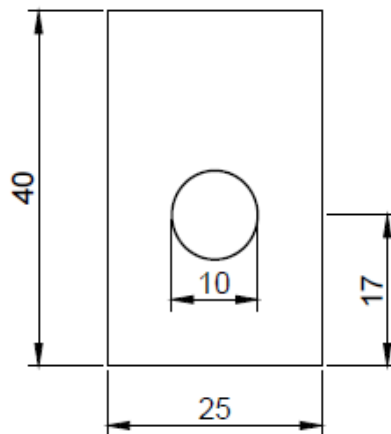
Sección de viga de concreto con refuerzo de bambú
